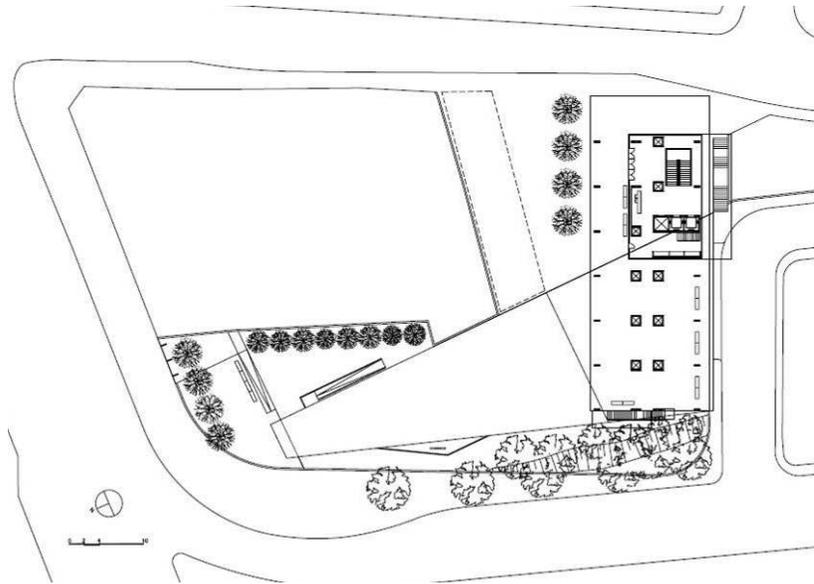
Planta: pavimento térreo (s/esc).
